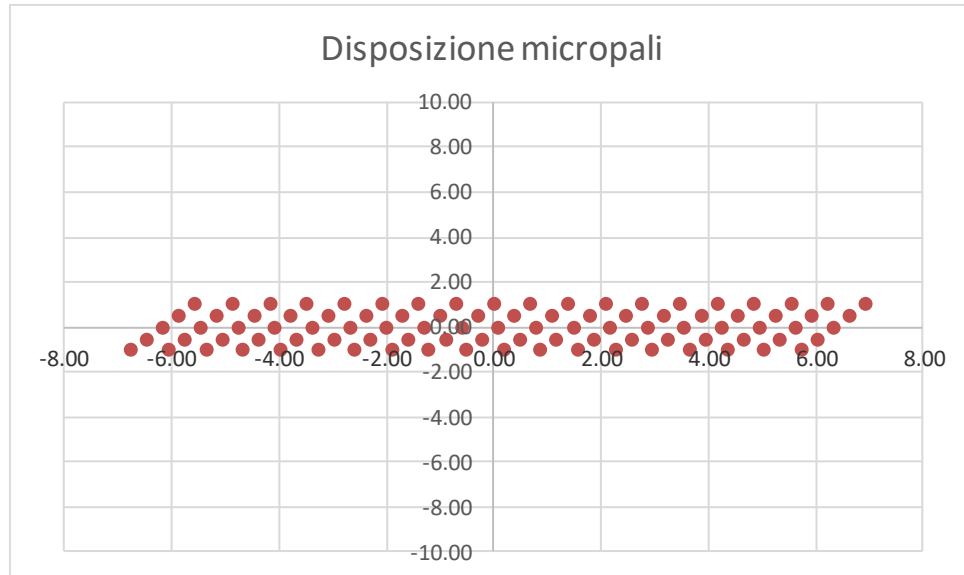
Disposizione dei micropali di fondazione in pianta
